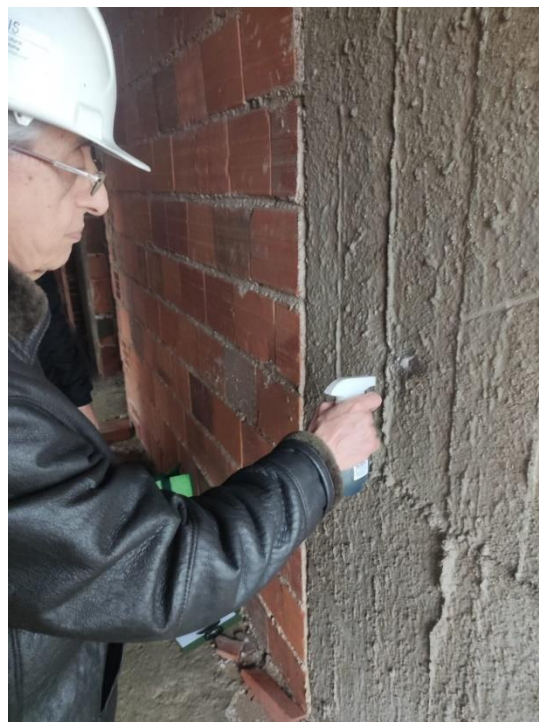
Aplicação da fenolftaleína na abertura do pilar P37 (8º Pav. Tipo).
